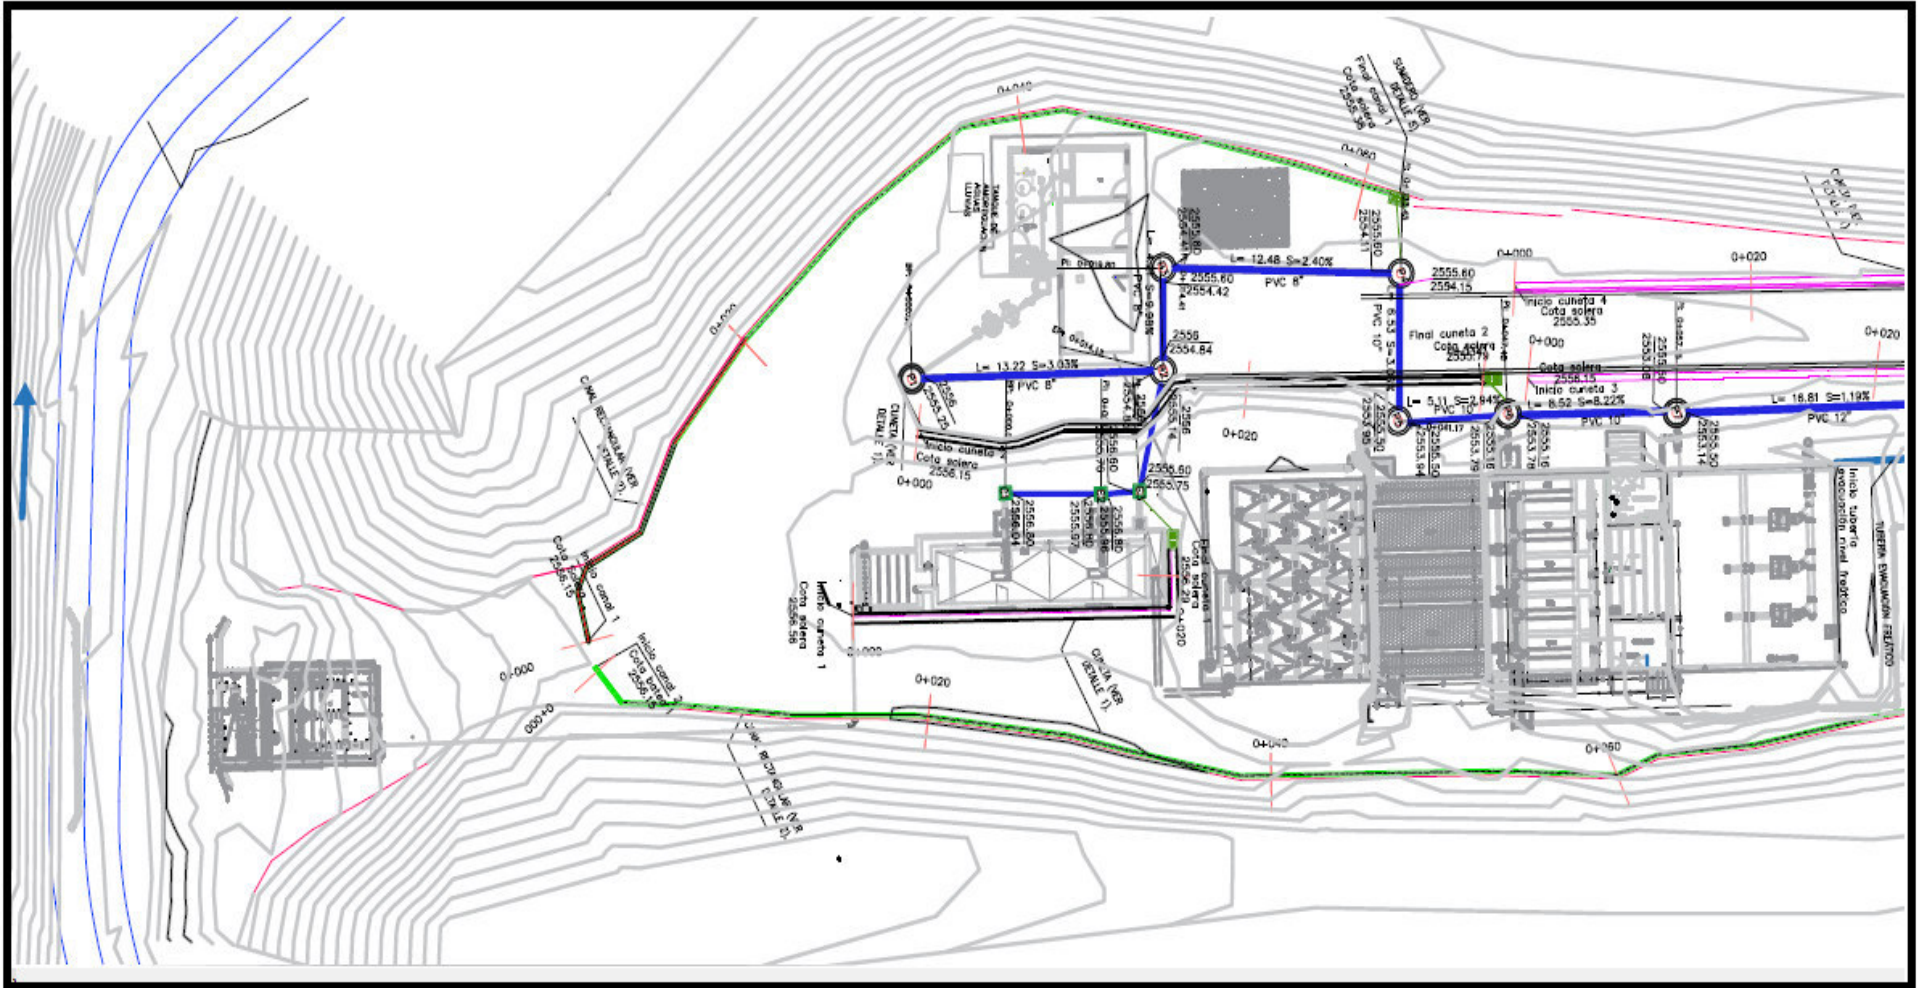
Plano en planta de la nueva implantación de la PTAP. (Parte 1).
